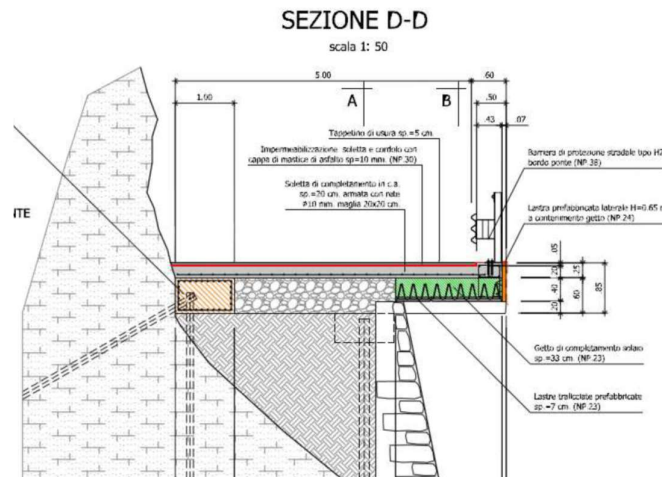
Sezione progetto esecutivo "Lavori concernenti la frana sul torrente bitto-consolidamento dei versanti-realizzazione delle infrastrutture viarie per il collegamento dell'abitato di Bema con il fondo valle- lotto b- stralcio b1 + b2")
